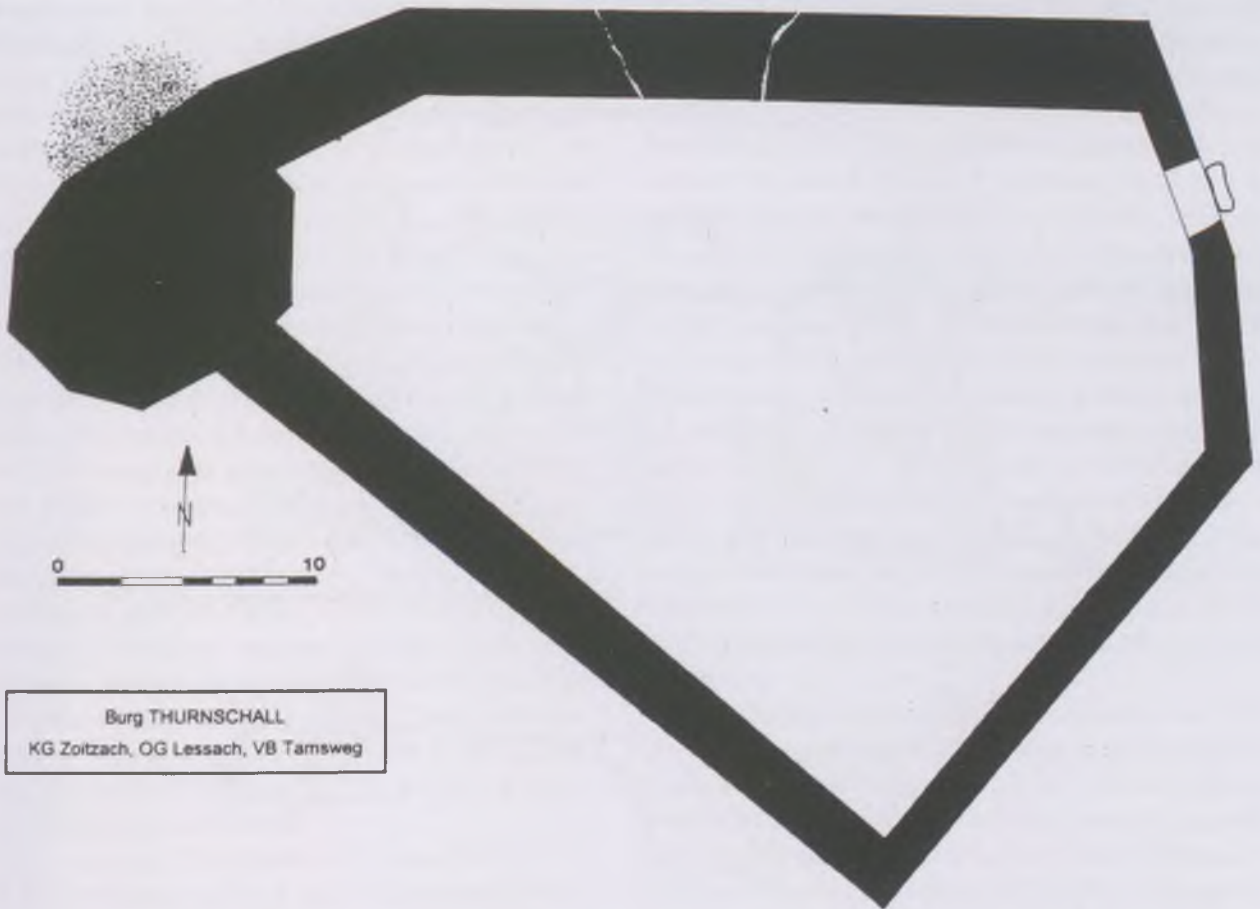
Burg Thurnschall: Grundrissplan (Planerstellung und Umzeichnung: U. Hampel).
